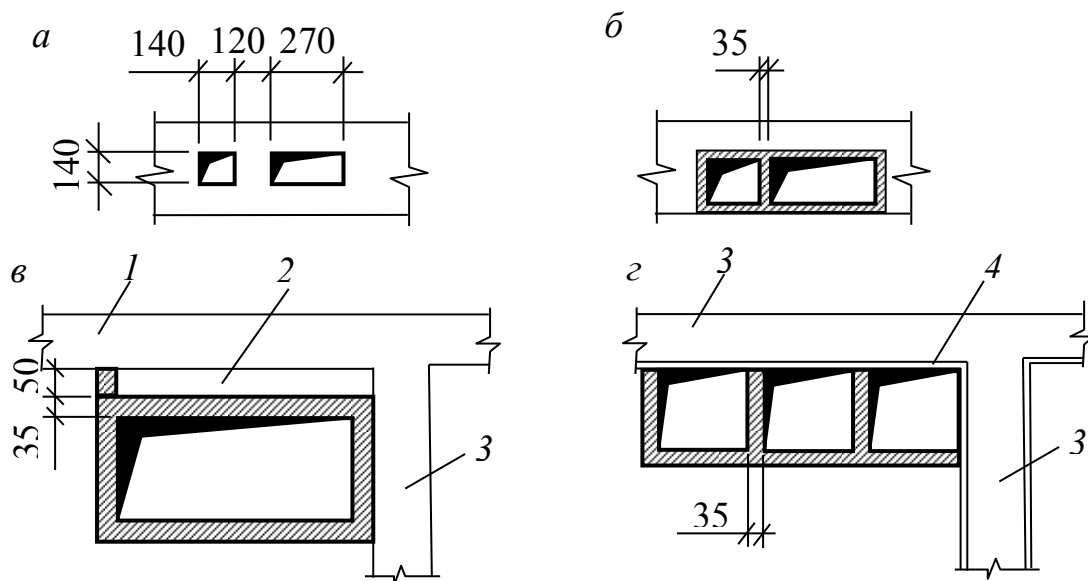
Схема устройства вентиляционных каналов: *а* – в кирпичных стенах; *б* – в бороздах стены, заделываемых плитами; *в* – с воздушной прослойкой у наружной стены; *г* – у внутренней стены; *1* – наружная стена; *2* – воздушная прослойка; *3* – внутренняя стена; *4* – штукатурка
